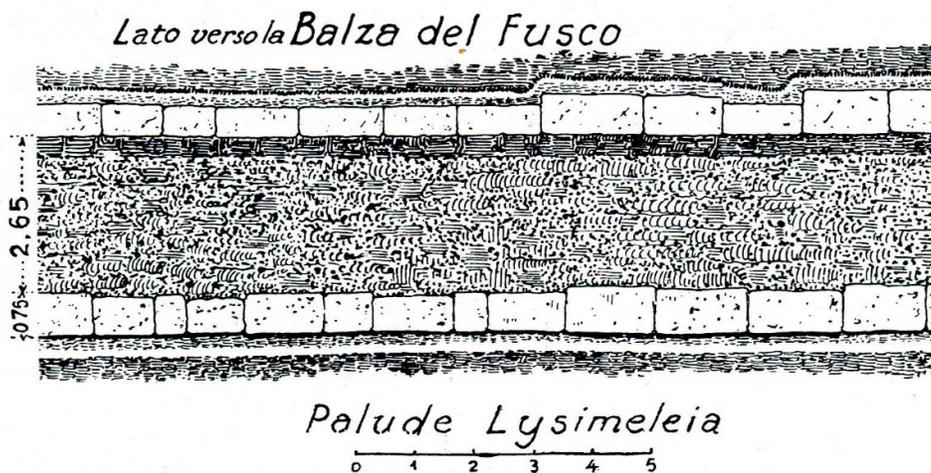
Pianta della fondazione di un tratto del muro d'argine sottostante alla balza del Fusco, rilevato dall'Orsi.
